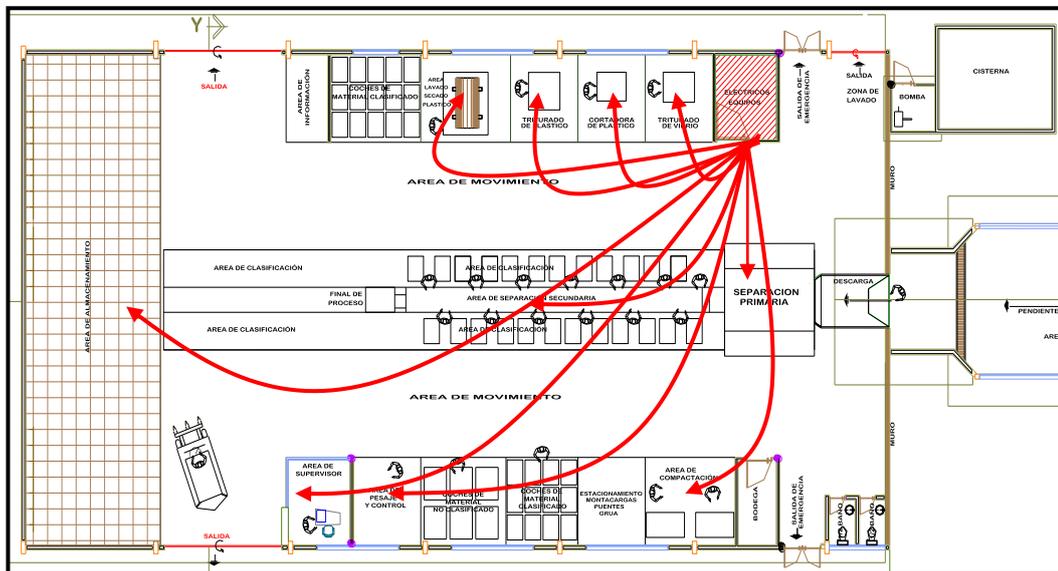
Vista arquitectónica y distribución de sistema eléctrico hacia las unidades de procesado desde tablero de control
